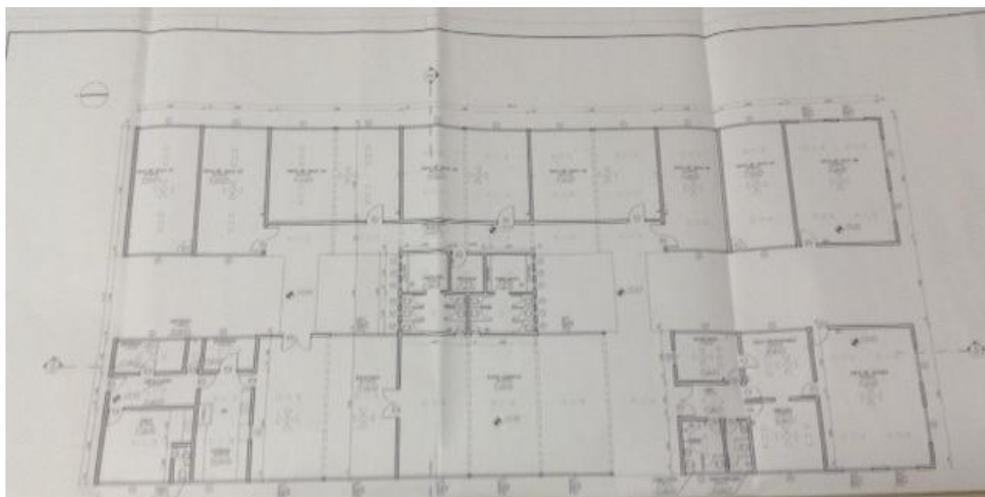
Planta baixa da Escola Municipal Tagore localizada na cidade do Rio de Janeiro, RJ.
